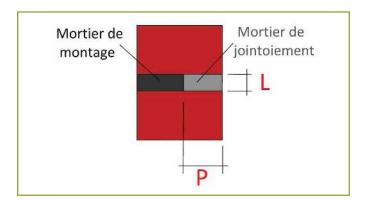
Schéma en coupe du principe de jointoiement (Dessin de Cédric Houel)
